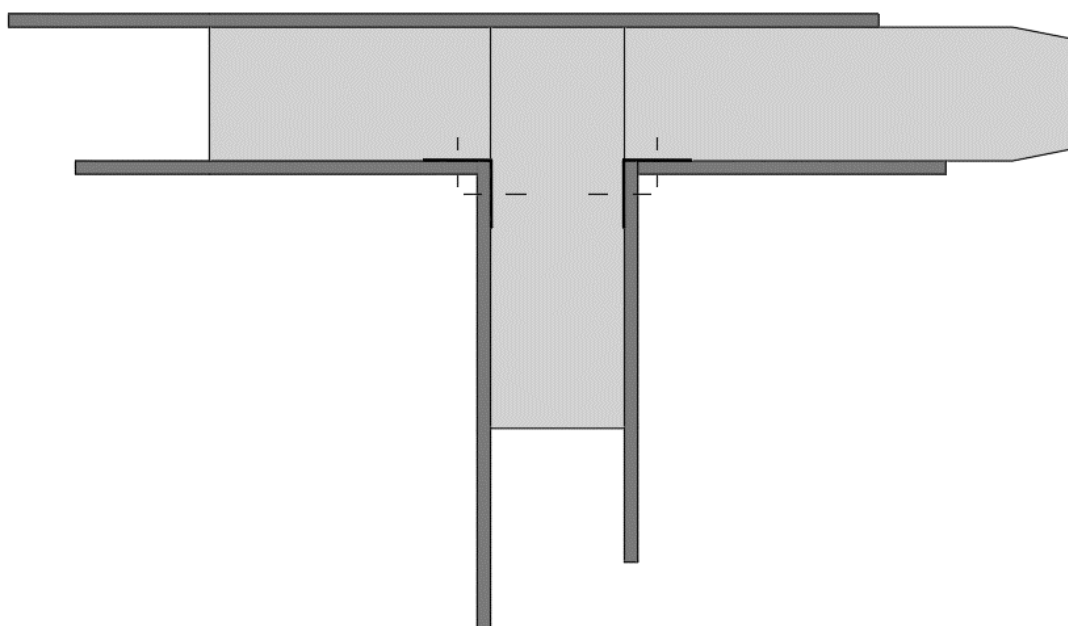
Vista em planta de ligação em T dos painéis sandwich.
